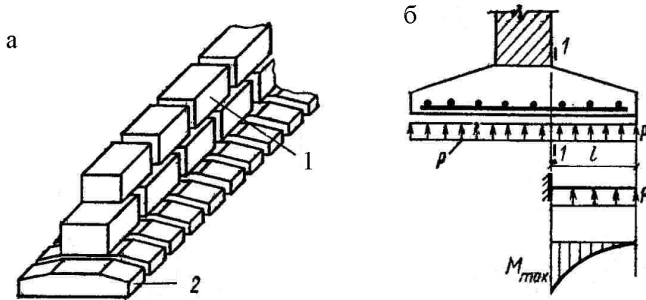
Збірні стрічкові фундаменти під стінами:
